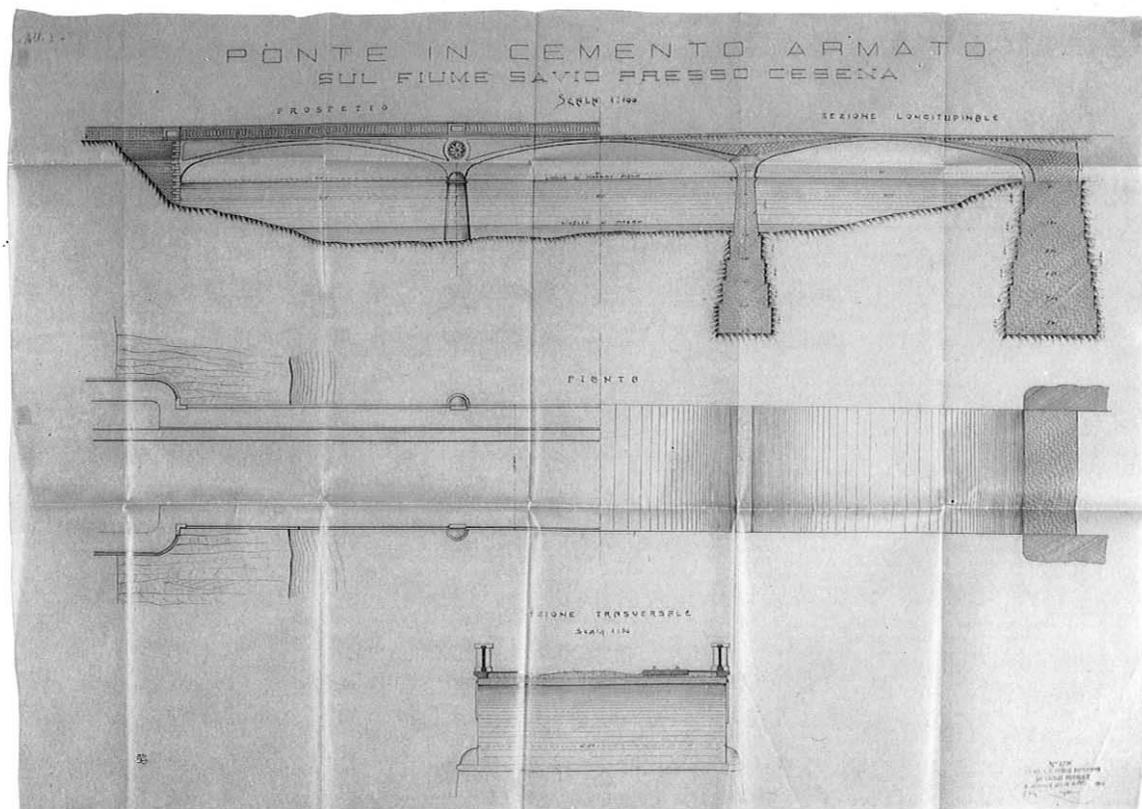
Progetto del nuovo ponte sul Savio - Sezioni e particolari costruttivi.
